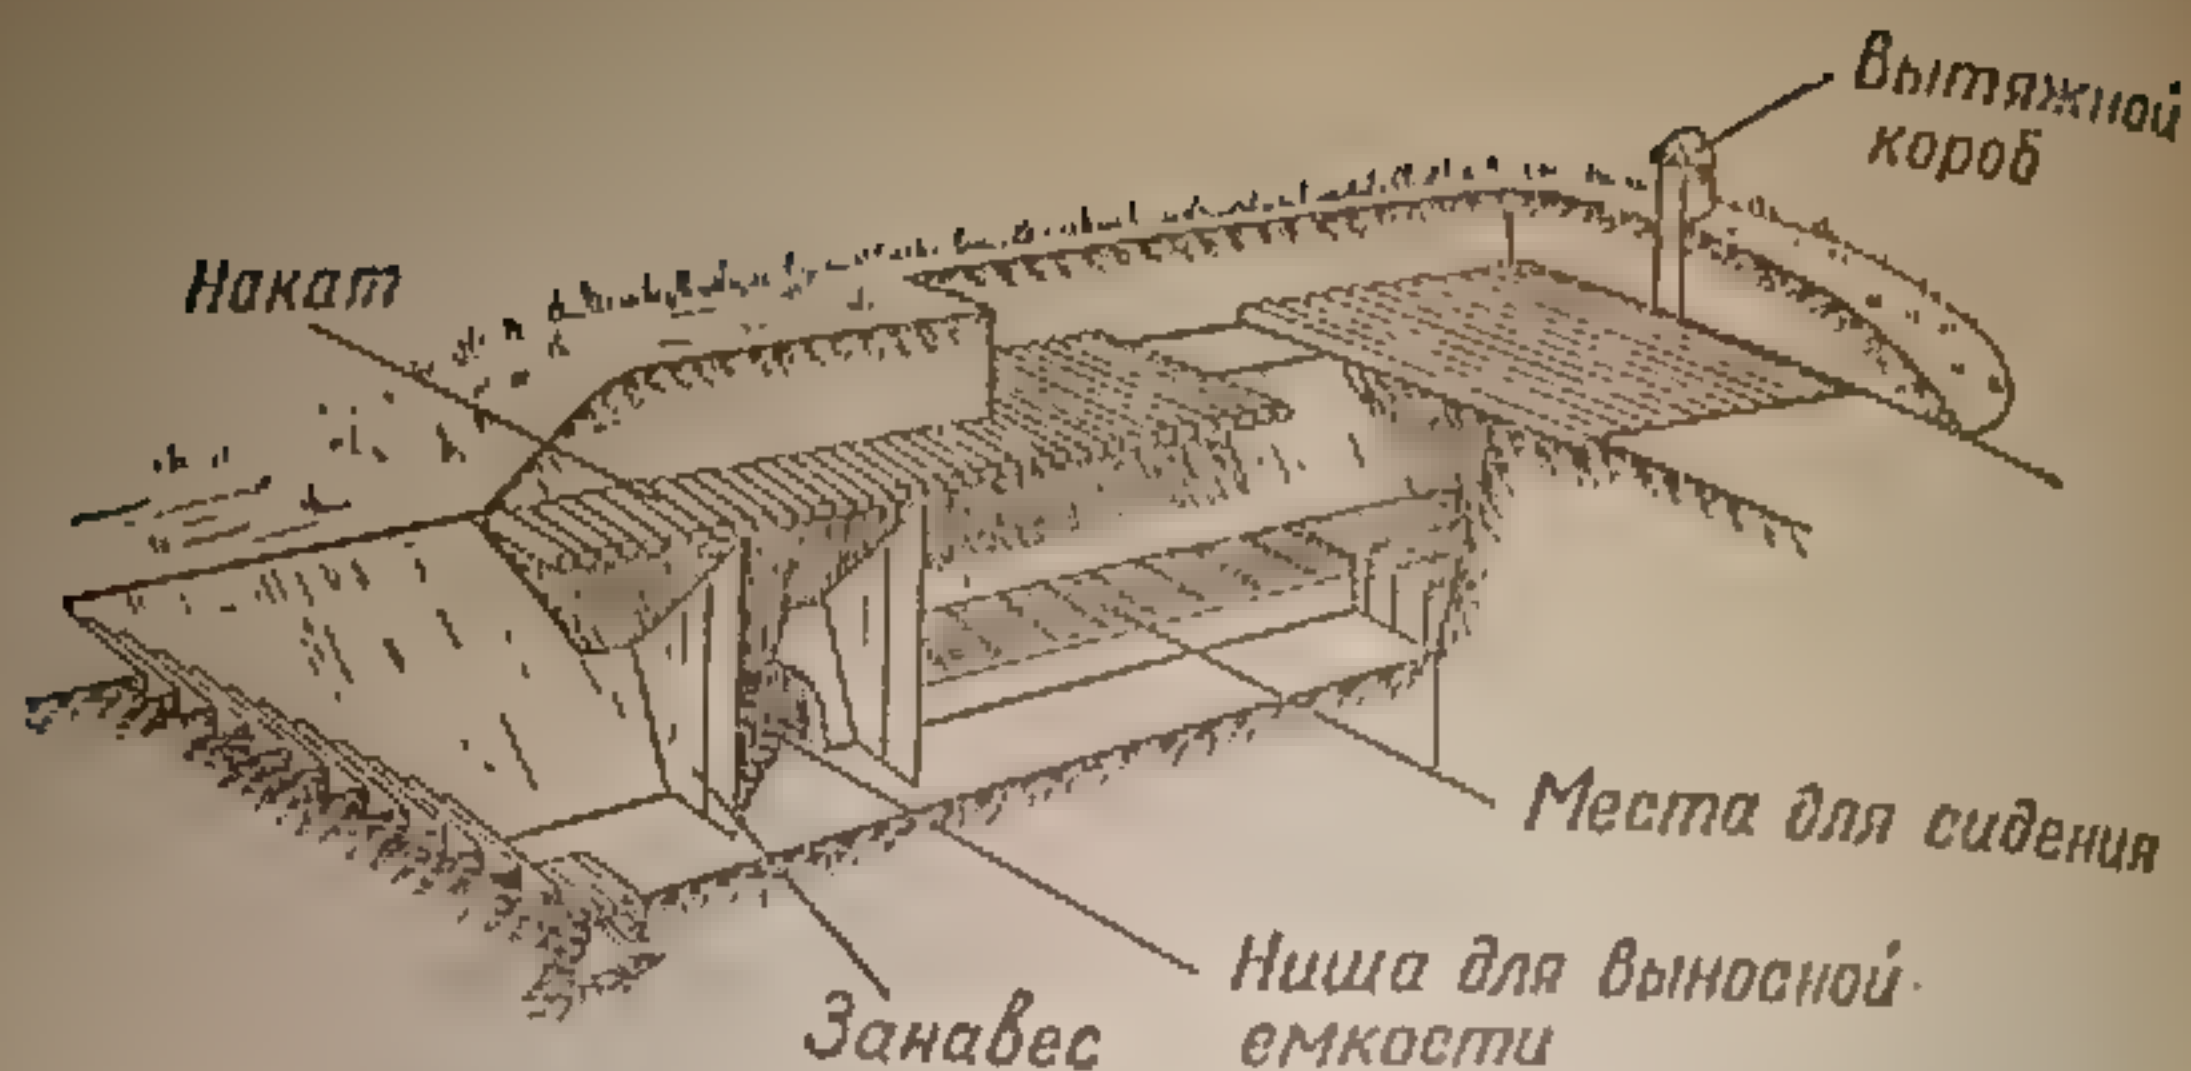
Укрытие на 10 человек из лесоматериалов (разрез).
